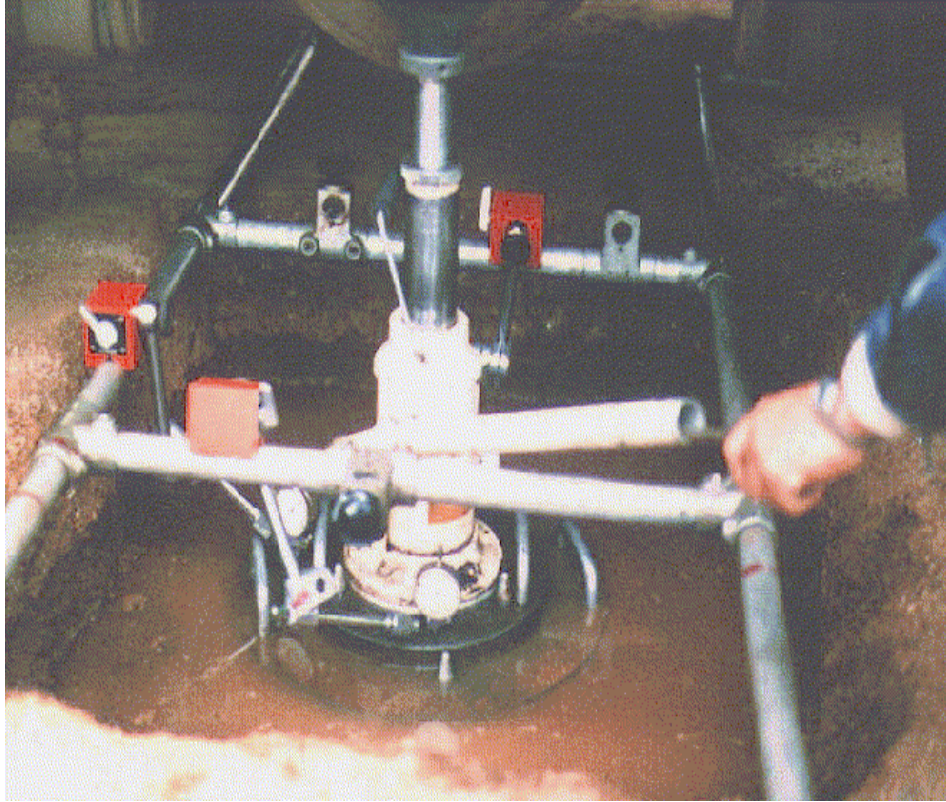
Ensayo de colapso con placa in situ (Aravena R. y Kramer P., 1984).
